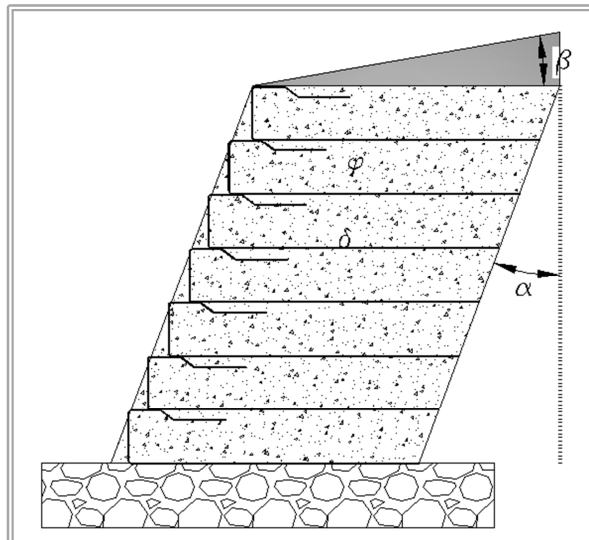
Sección tipo de muro reforzado con trasdós y relleno inclinado.
